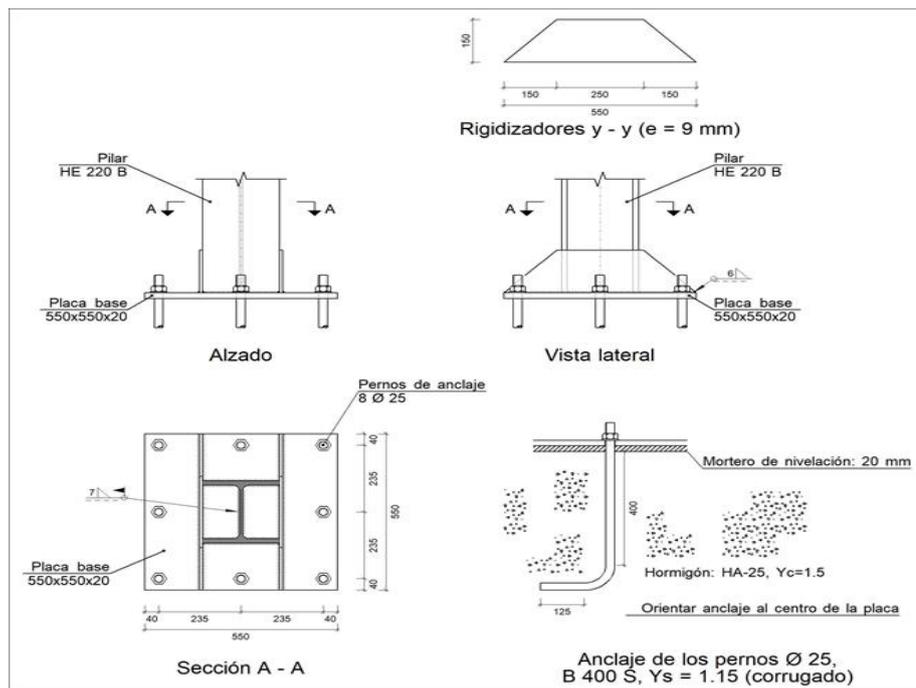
Esquema 2D de la placa de anclaje tipo de las placas centrales.
